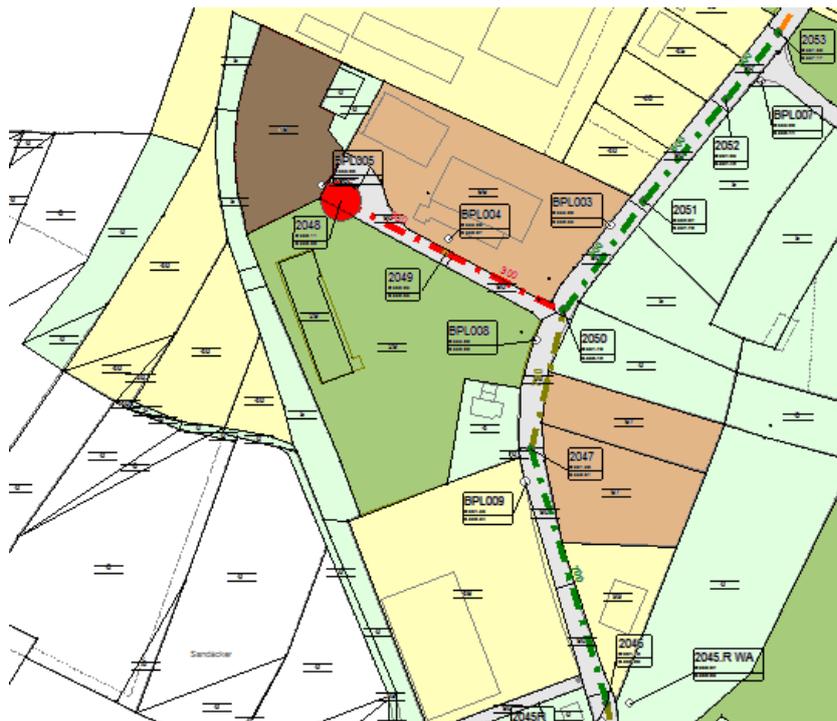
Lageplanausschnitt Prognosezustand, T=3a, unsaniert
